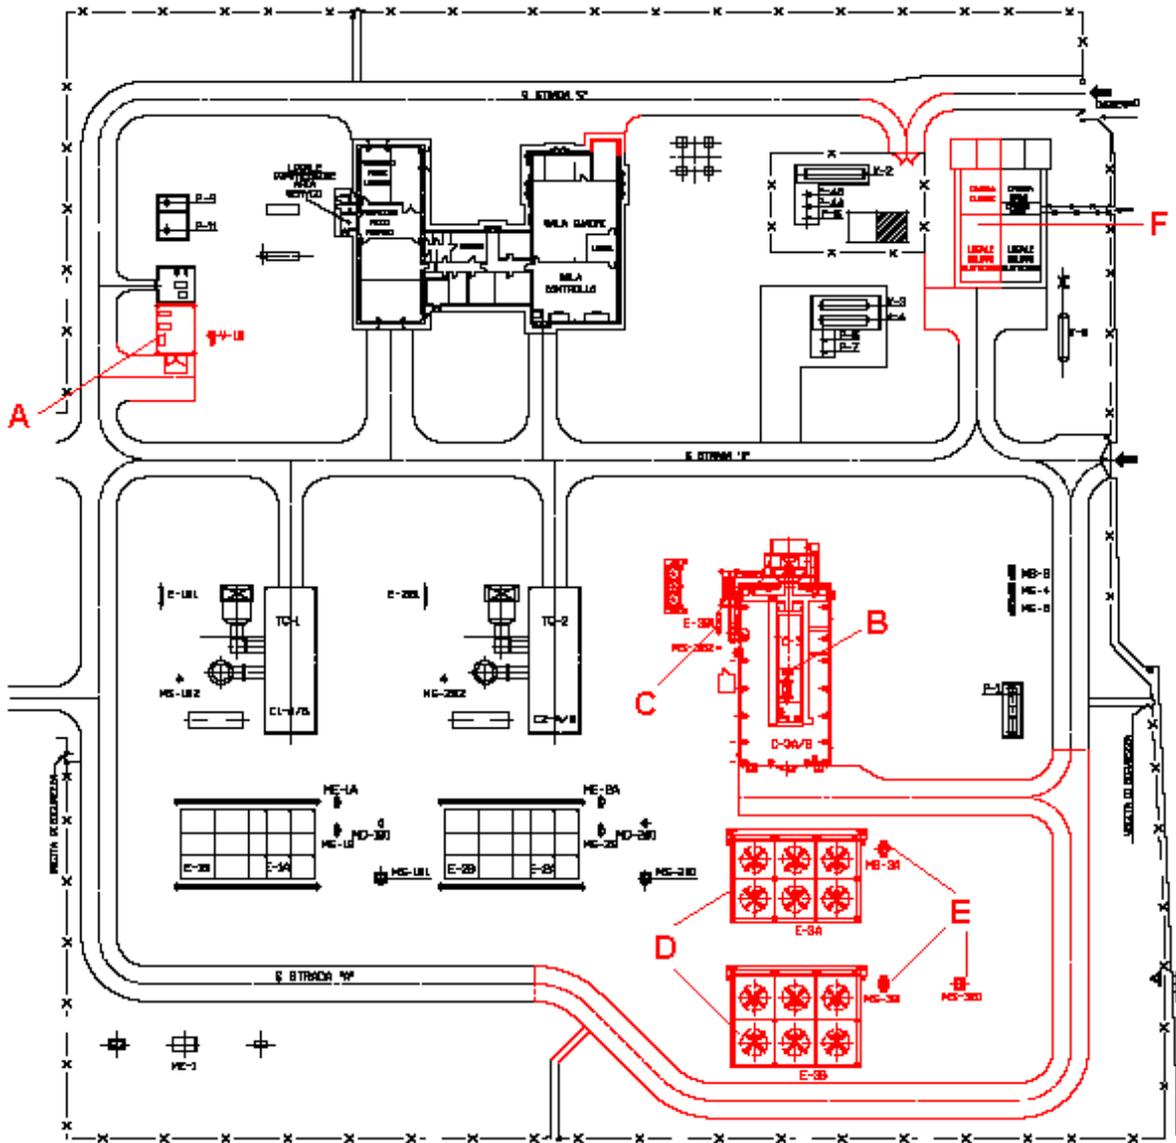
b – Centrale di Stoccaggio di Settala, area compressione: dettaglio della nuova configurazione impiantistica
